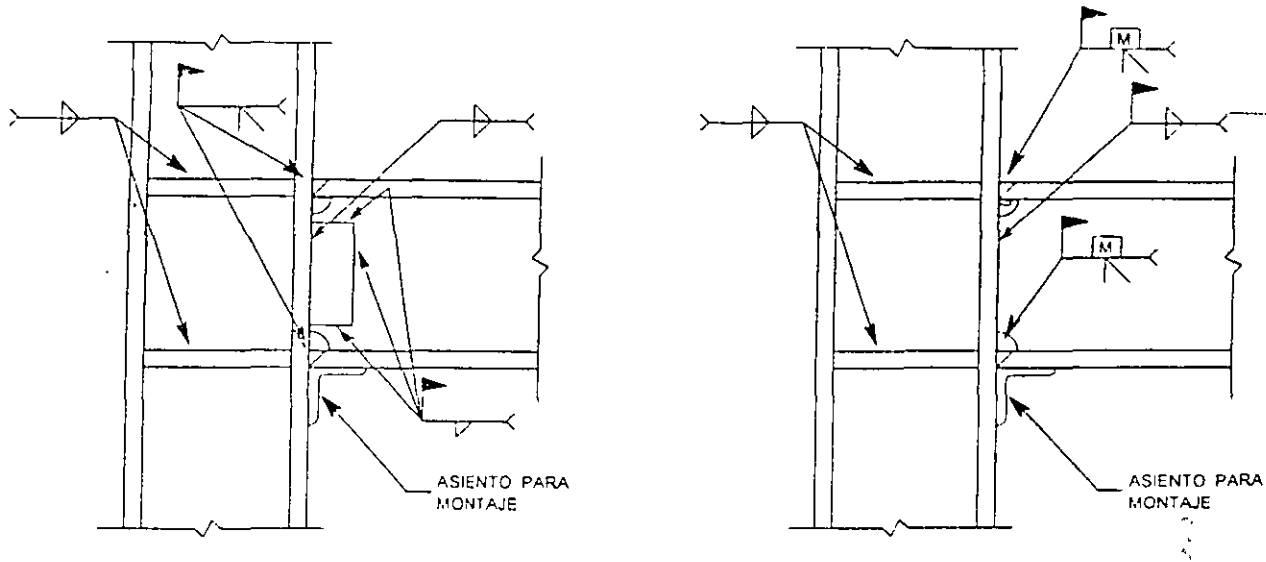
Conexiones a momento empleando soldadura tanto en el alma como en los patines
